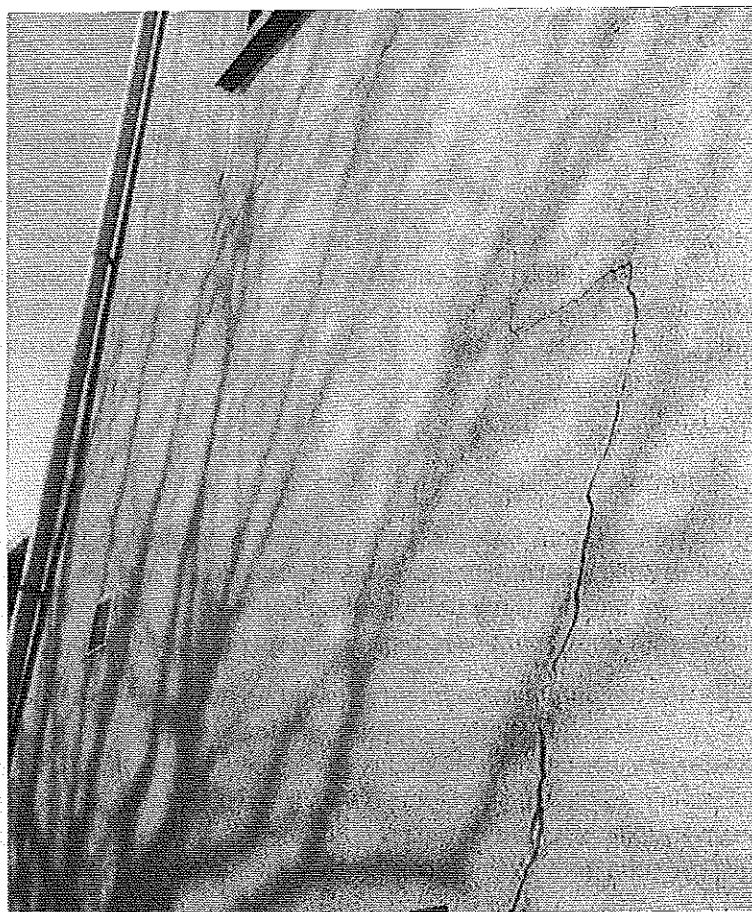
Fissure verticale de rupture de la maçonnerie due au tassement de la partie gauche de la façade. © J. Putatti
